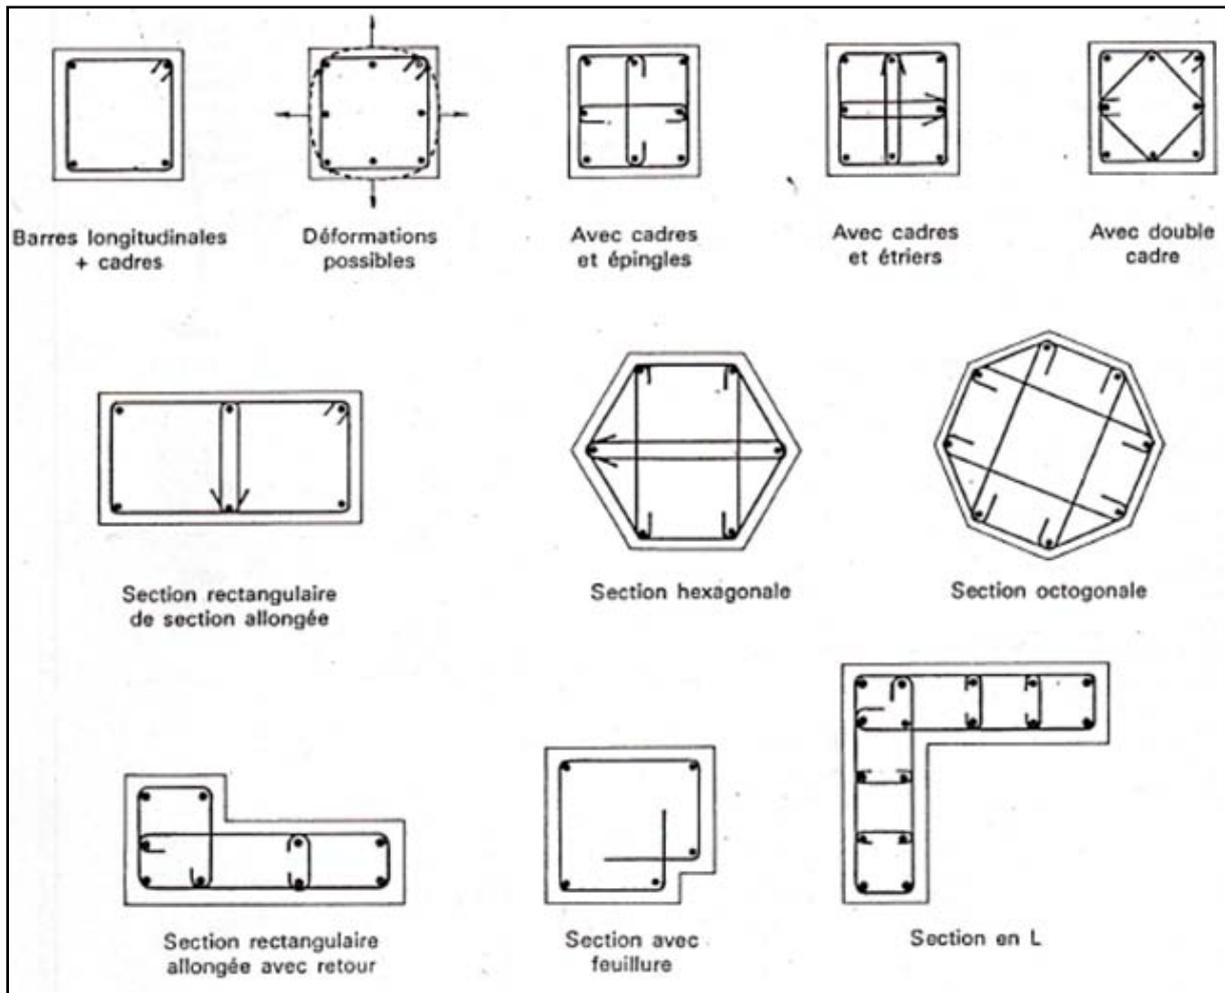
Exemple de dispositions des aciers transversaux dans les poteaux (coupes transversales)
